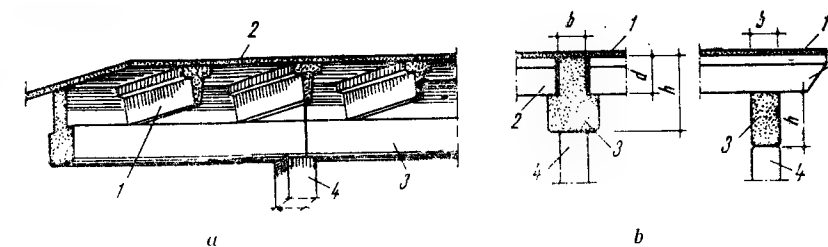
Planșeu din plăci și grinzi prefabricate din beton :
